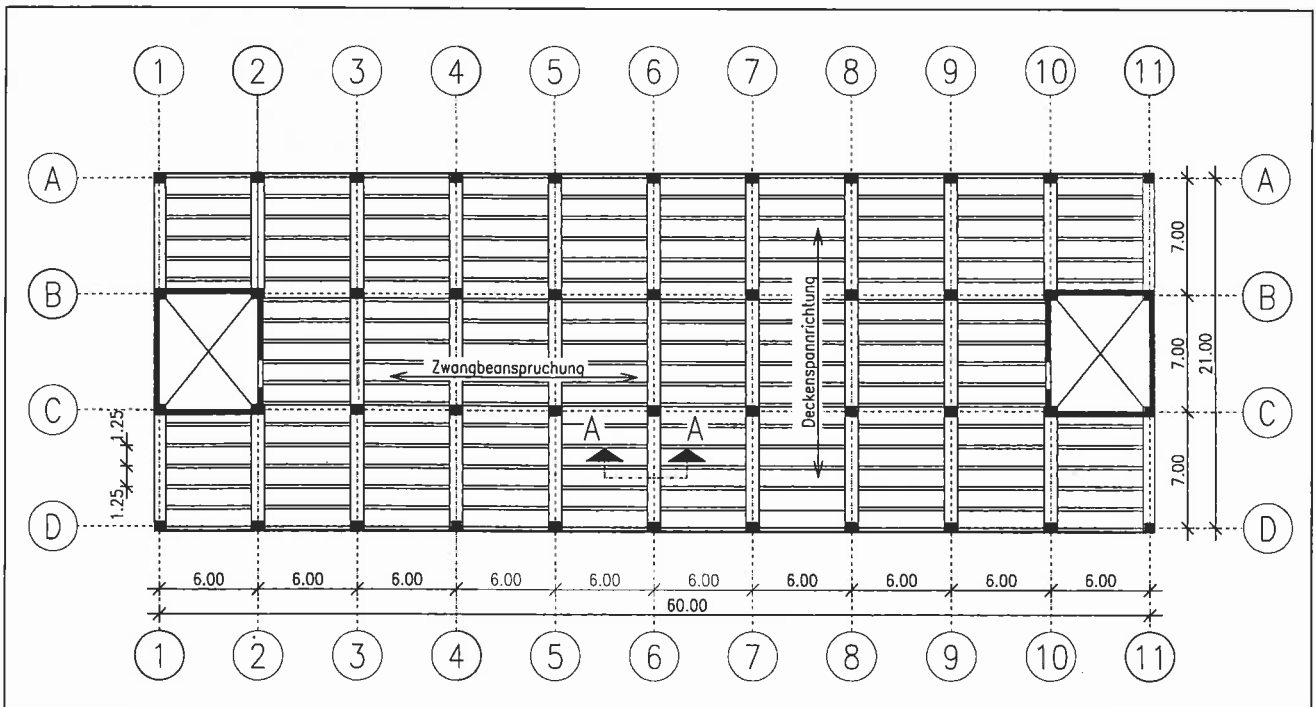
Grundriss der Deckenplatte eines Parkhauses
